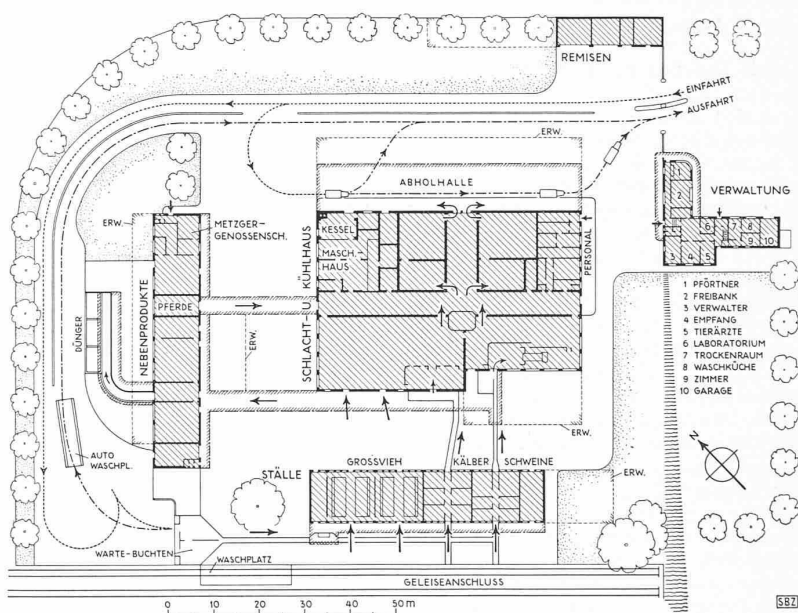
Lageplan 1:1500, mit Angabe des «Einbahnverkehrs» im Betrieb
